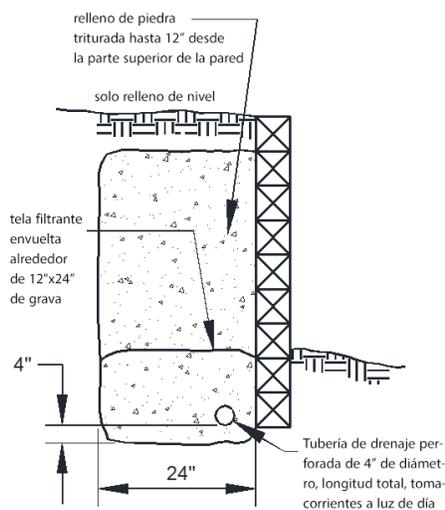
MURO DE MADERA RELLENO Y DRENAJE
